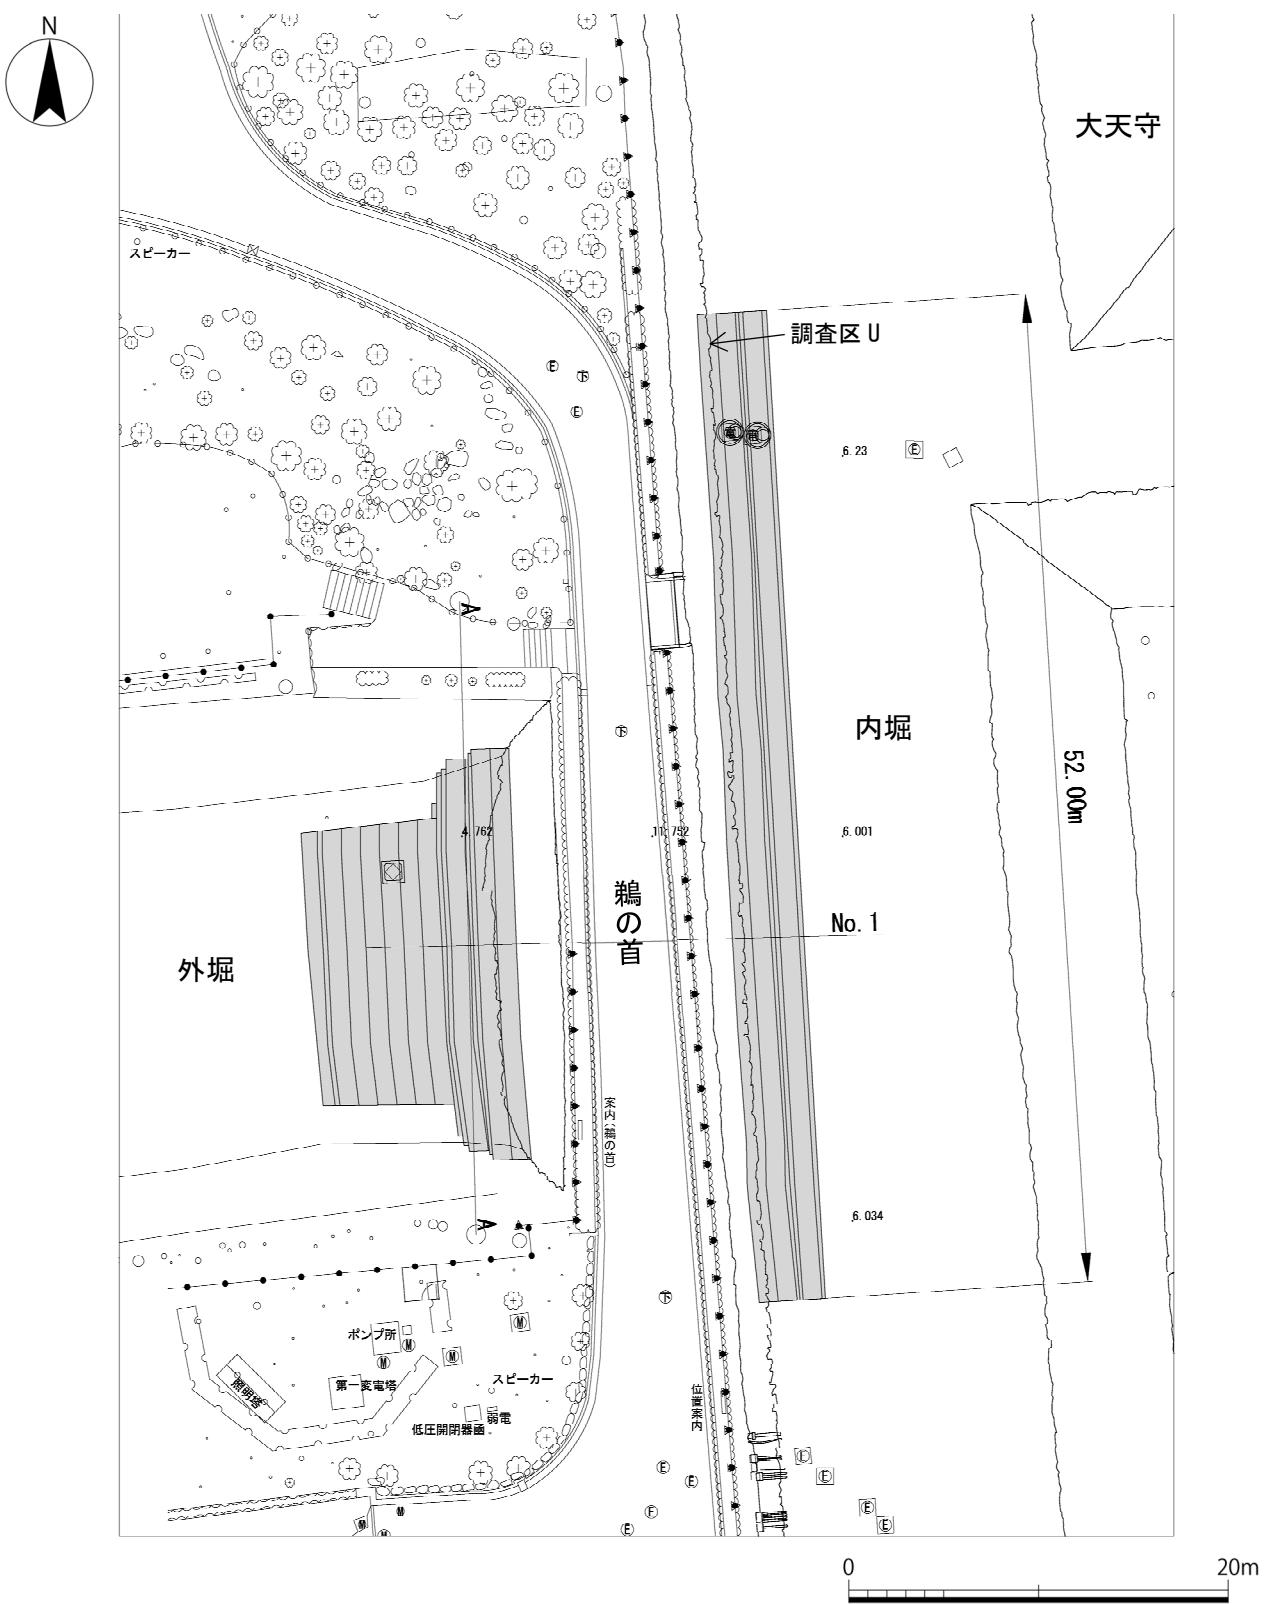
布団籠による前押さえ対策（U66, S10）平面図 1/400
